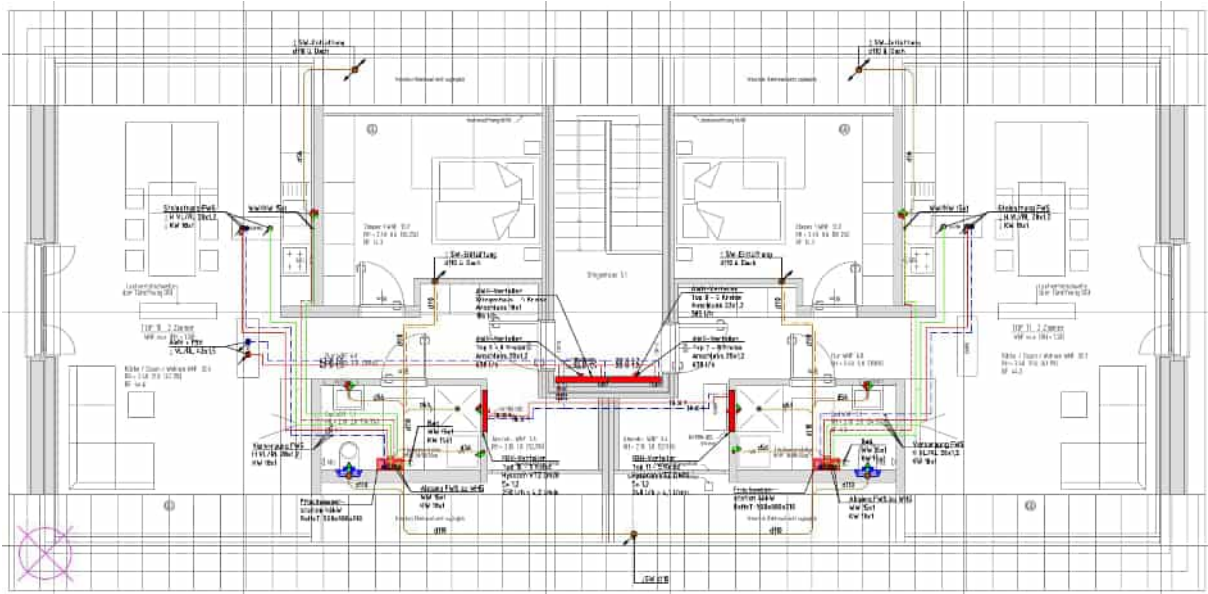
Grundriss DG mit Lage der Außenwandheizungs-Heizkreisverteiler, der Unterverteiler in den DG-Wohnungen sowie der Horizontalverteilung im DG; Planungsteam E-Plus
